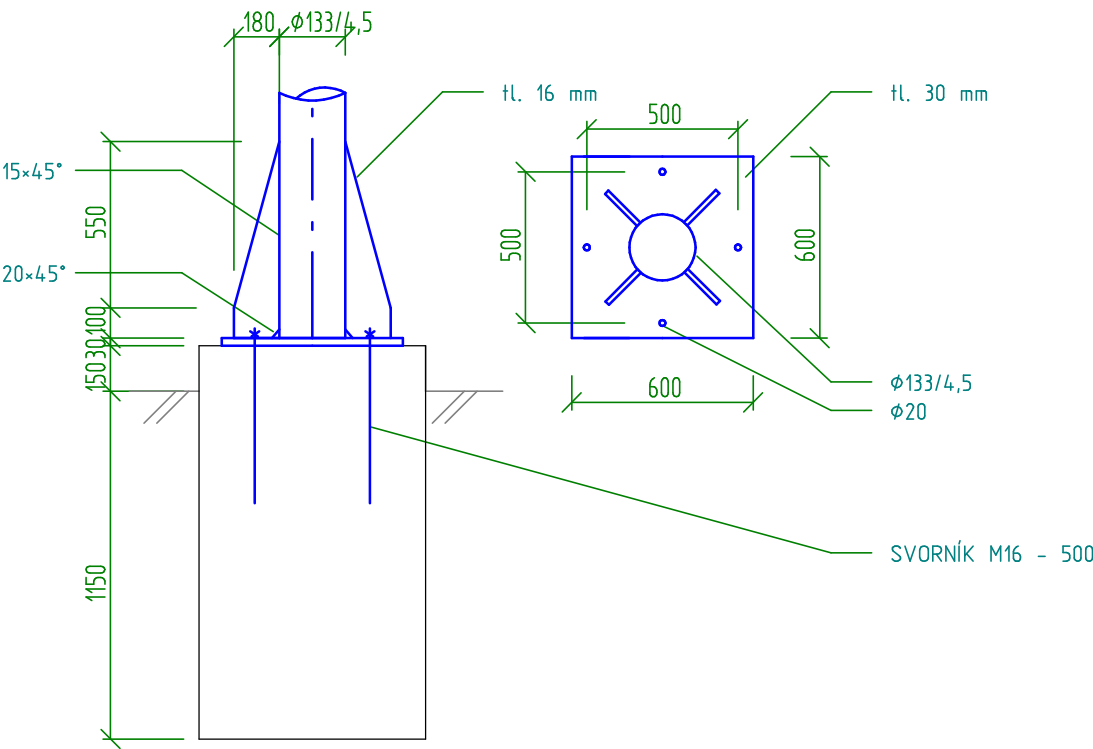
DETAIL BETONOVÉ PATKY OPĚRY U3, U5 1 : 25
